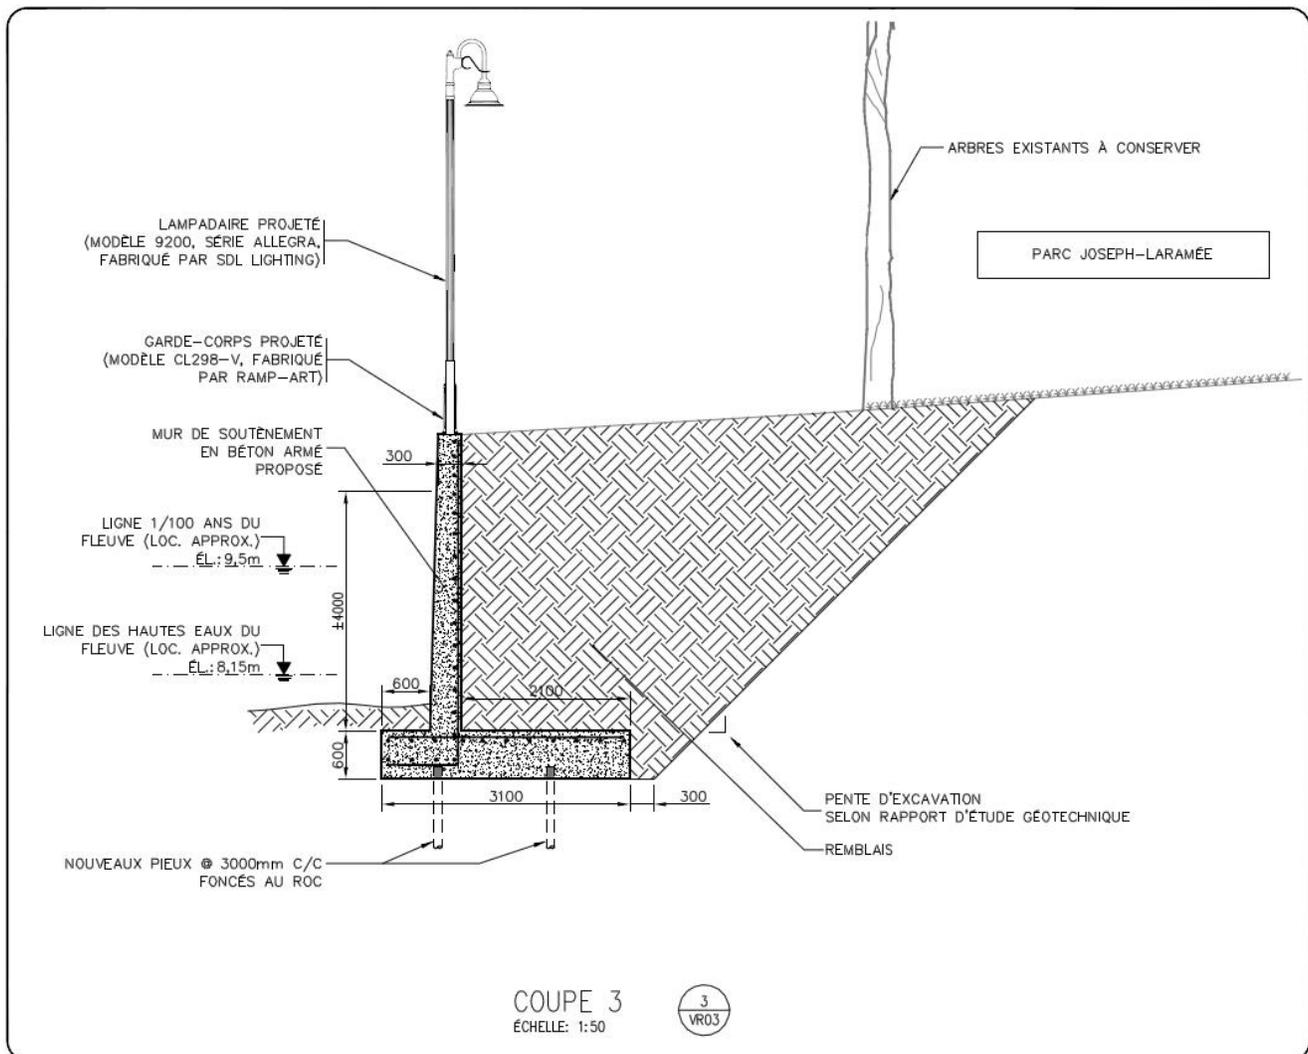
Vue en coupe de la construction d'un nouveau mur de béton au tronçon 3 (Source : Génipur, 2015).
